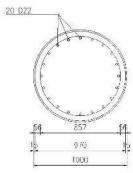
Dimensi Pile Cap 2 Abutment dan 4 Pear
